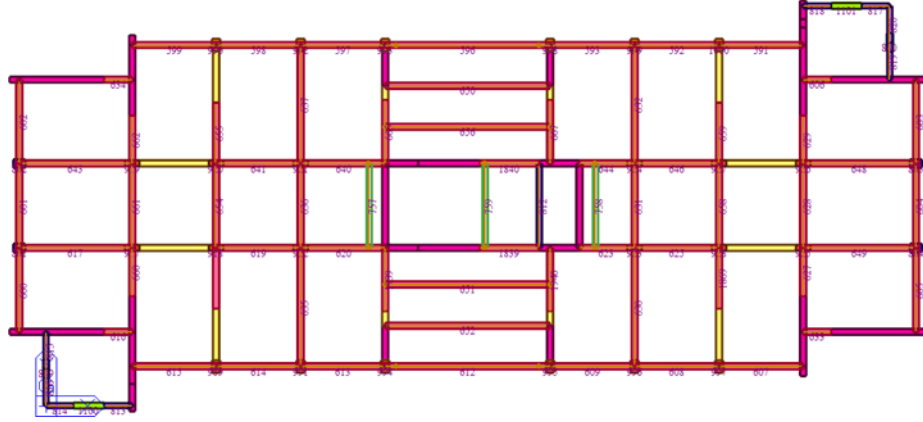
Statik analiz modelinde yapının zemin kat tavan kalıp planı
